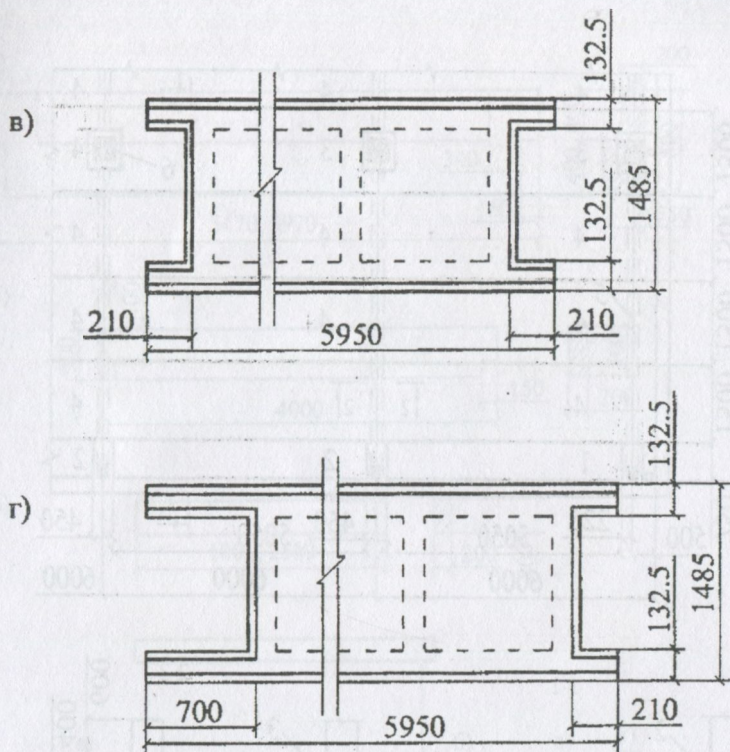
Залізобетонні ребристі плити перекриття для прямокутних ригелів: в – плити для колон середнього ряду; г – плити для колон з торця будівлі
